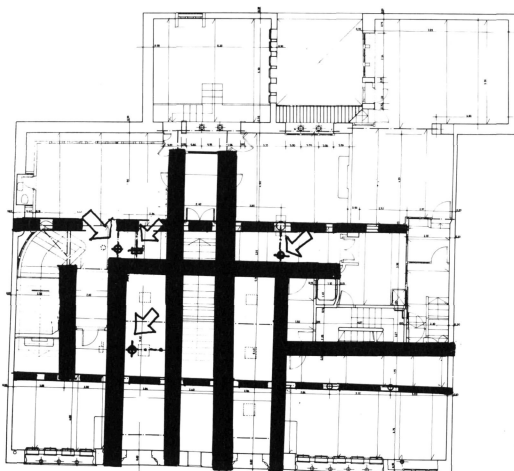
Los cuatro pilares exentos que arrancan del techo de la planta entresuelo. Los dos más próximos son los que provocaron el voladizo en el techo de la entreplanta.
